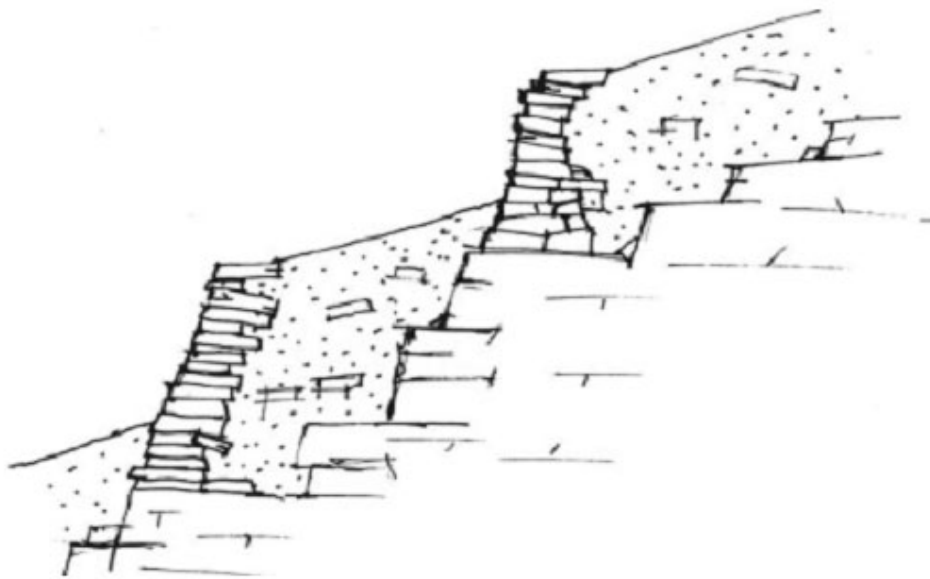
Coupe sur un versant de terrasse bâti sur des murs traditionnels, structure pierre sèche, en schiste. Source: Plan de développement durable de la vallée de la Drobie, PNR 07, décembre 2004
